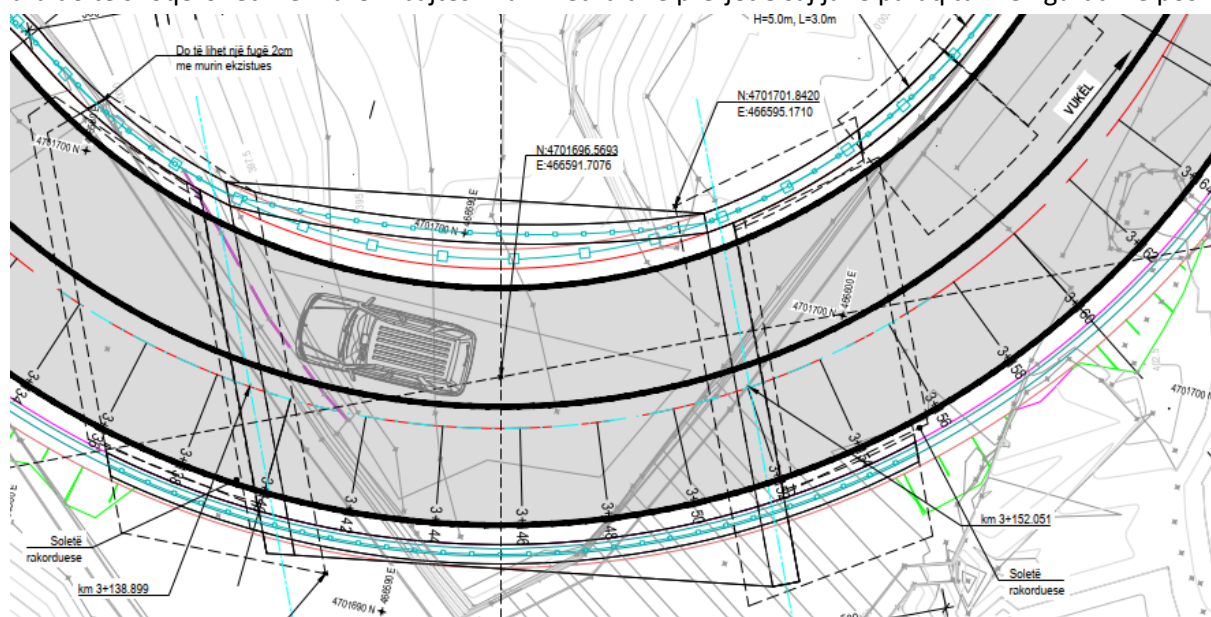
Planimetria e urës në rrugën Tamarë-Vukël
